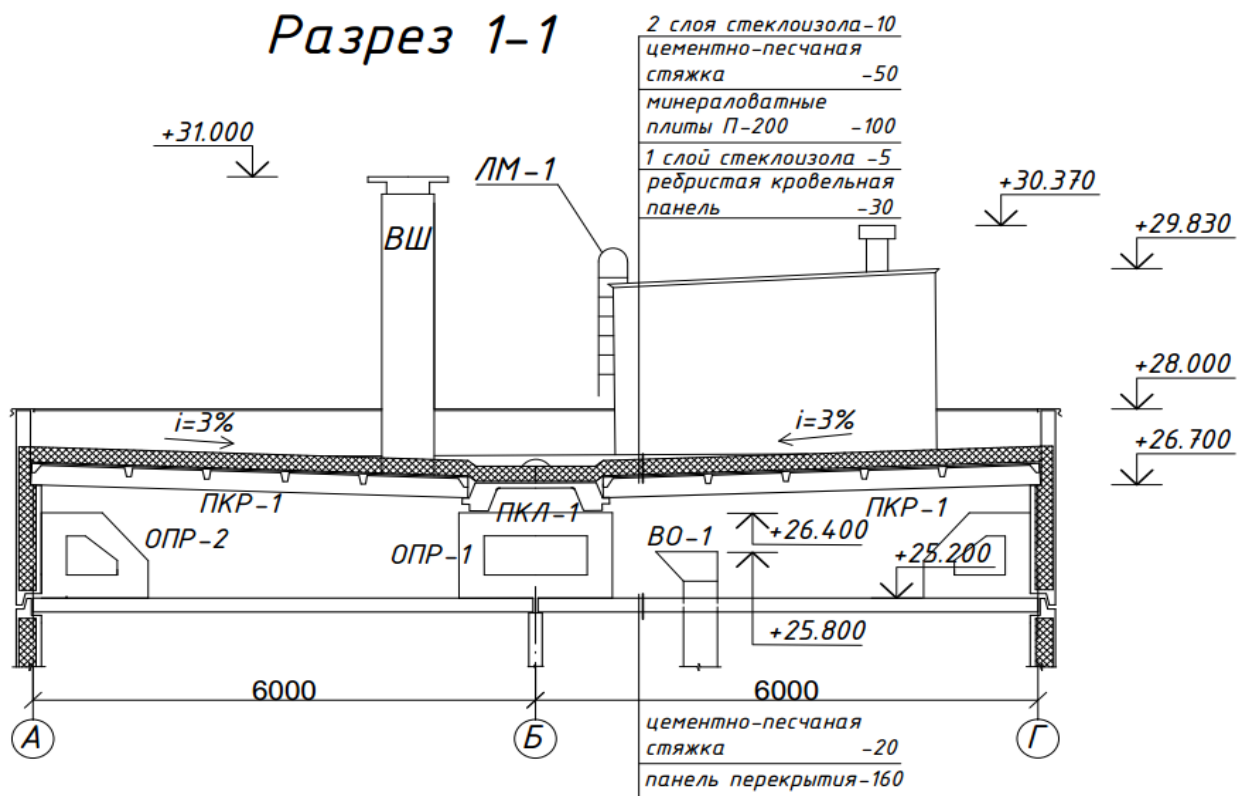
Теплый чердак и рулонная кровля. Поперечный разрез:
